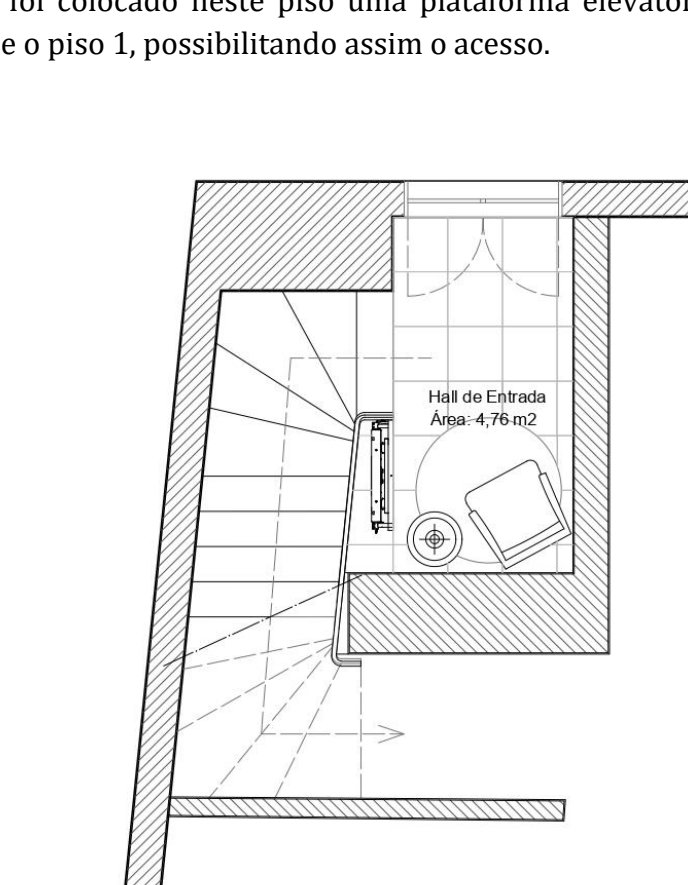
Planta de Apresentação Piso 0. Fonte: Ana Ferreira
